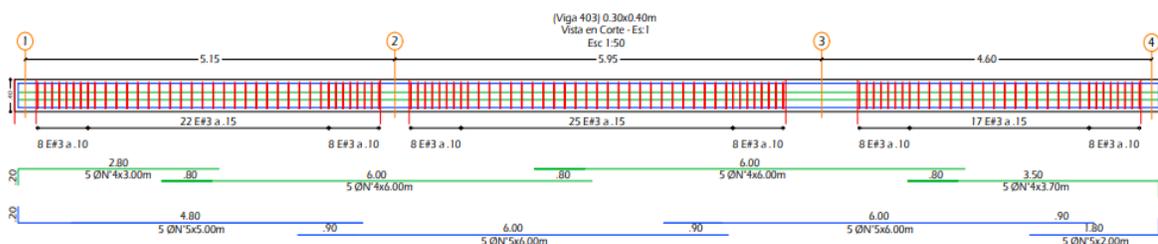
Despiece de viga principal 403 plano estructural Wiedii
